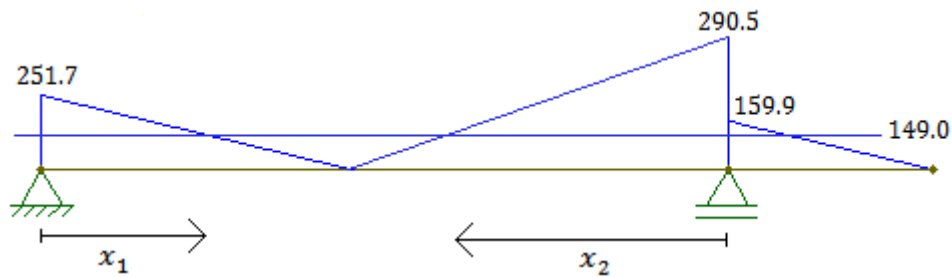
Esforço transversal da viga armada com GFRP (ACI 440.1R-06).
